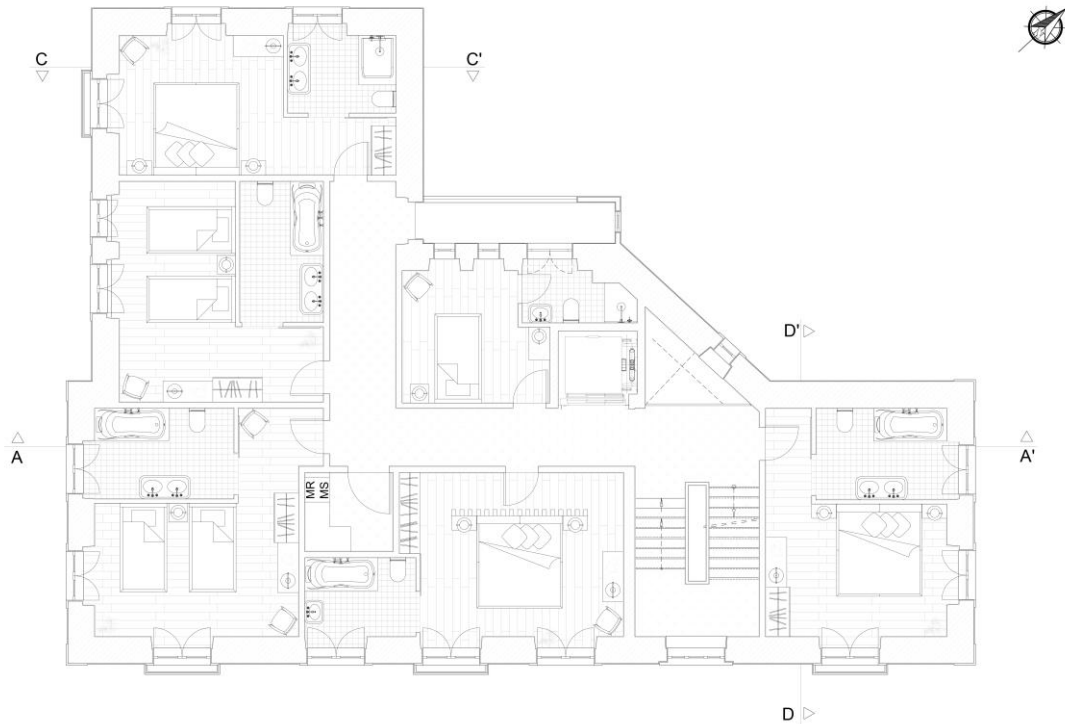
Planta de Apresentação Piso 1. Fonte: Autor
